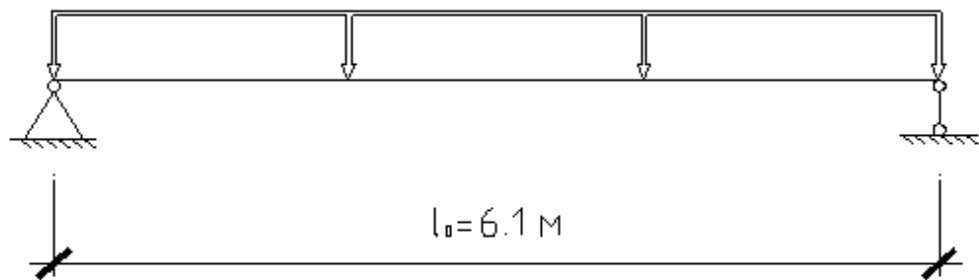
Схема завантаження багатопустотної панелі перекриття
